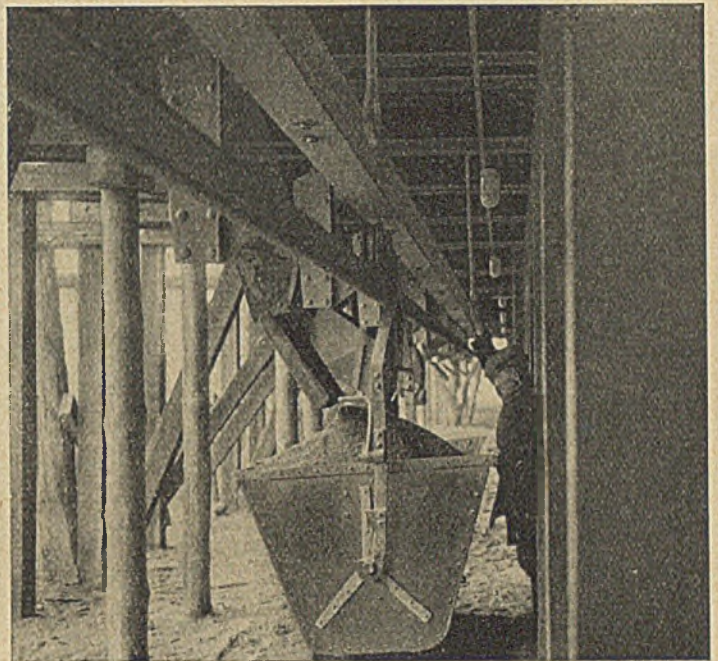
Hängewagen unter einem Sandbunker mit Segmentverschluß.
